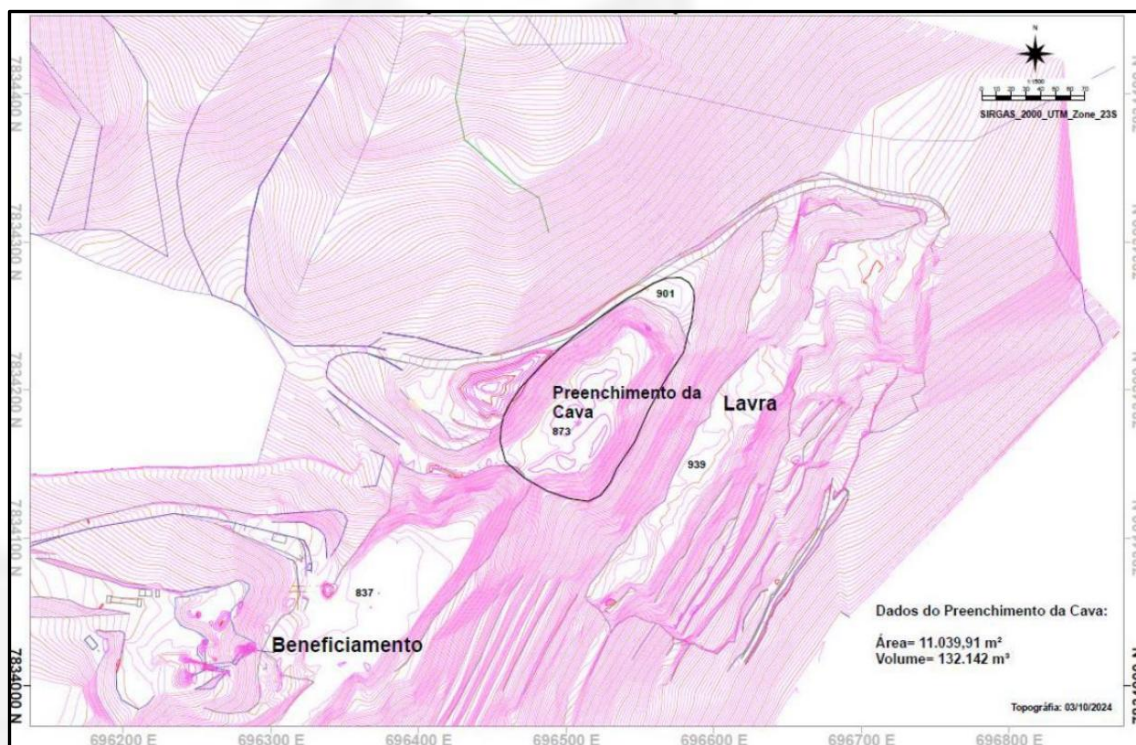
Planta planimétrica com detalhamento do preenchimento da cava.
